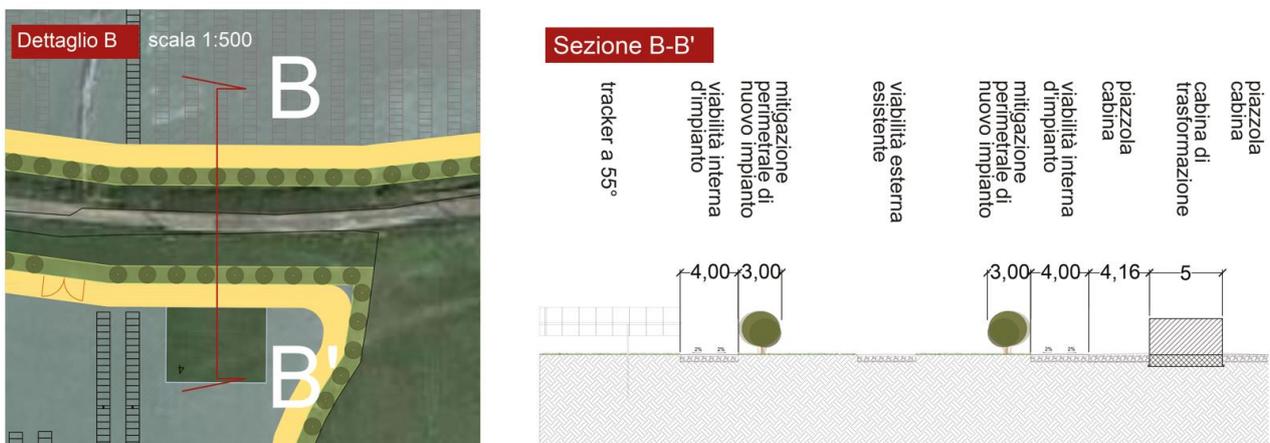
PARTICOLARE FASCIA DI MITIGAZIONE E CABINA DI TRASFORMAZIONE – SEZIONE N-S DELL’IMPIANTO – ESTRATTO DALL’ELABORATO GRAFICO SIL-PDT11)
